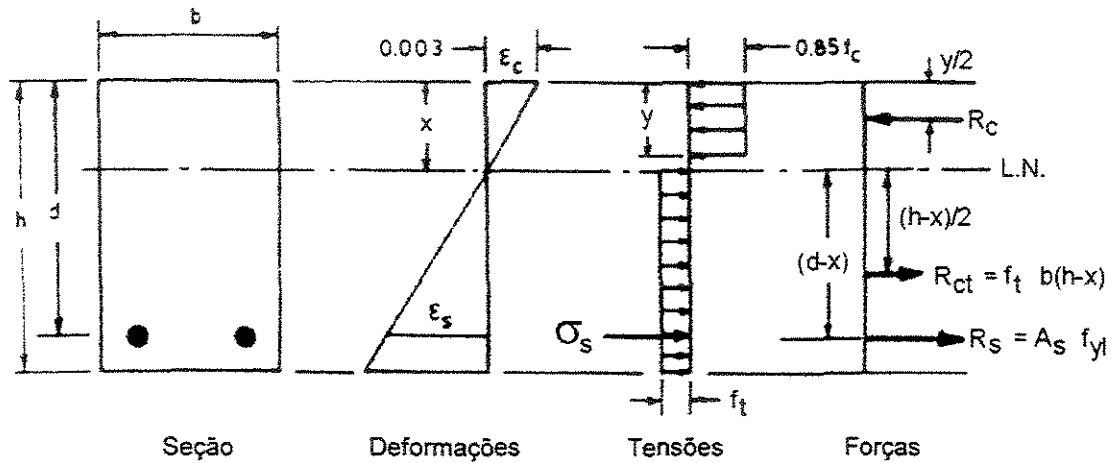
Viga retangular de concreto armado reforçada com fibras no momento último
